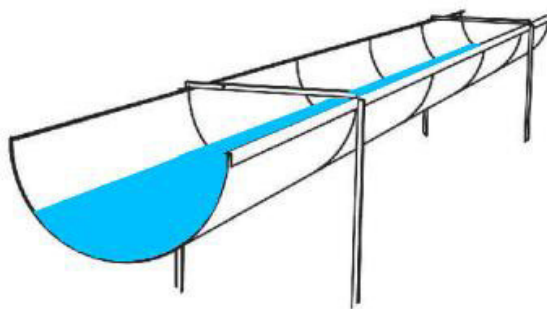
Sezione tipo canaletta mezzi tubi – intervento 12.
